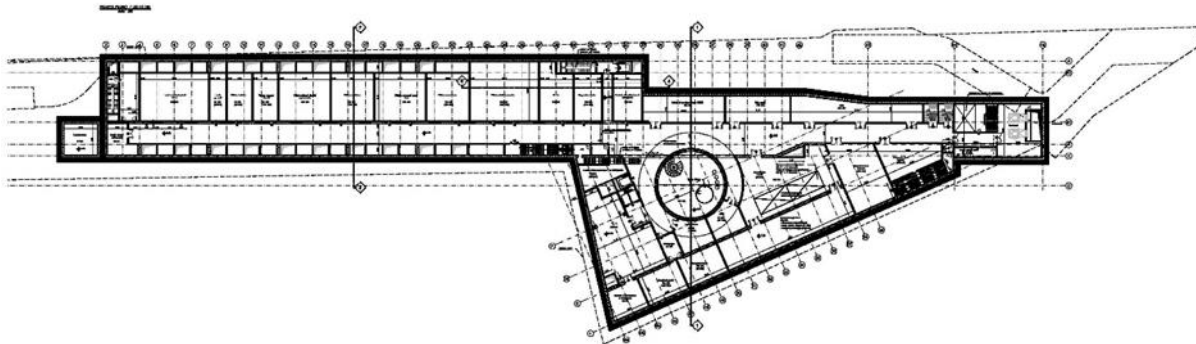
Deposito/officina Rebaudengo: Pianta Piano -1
